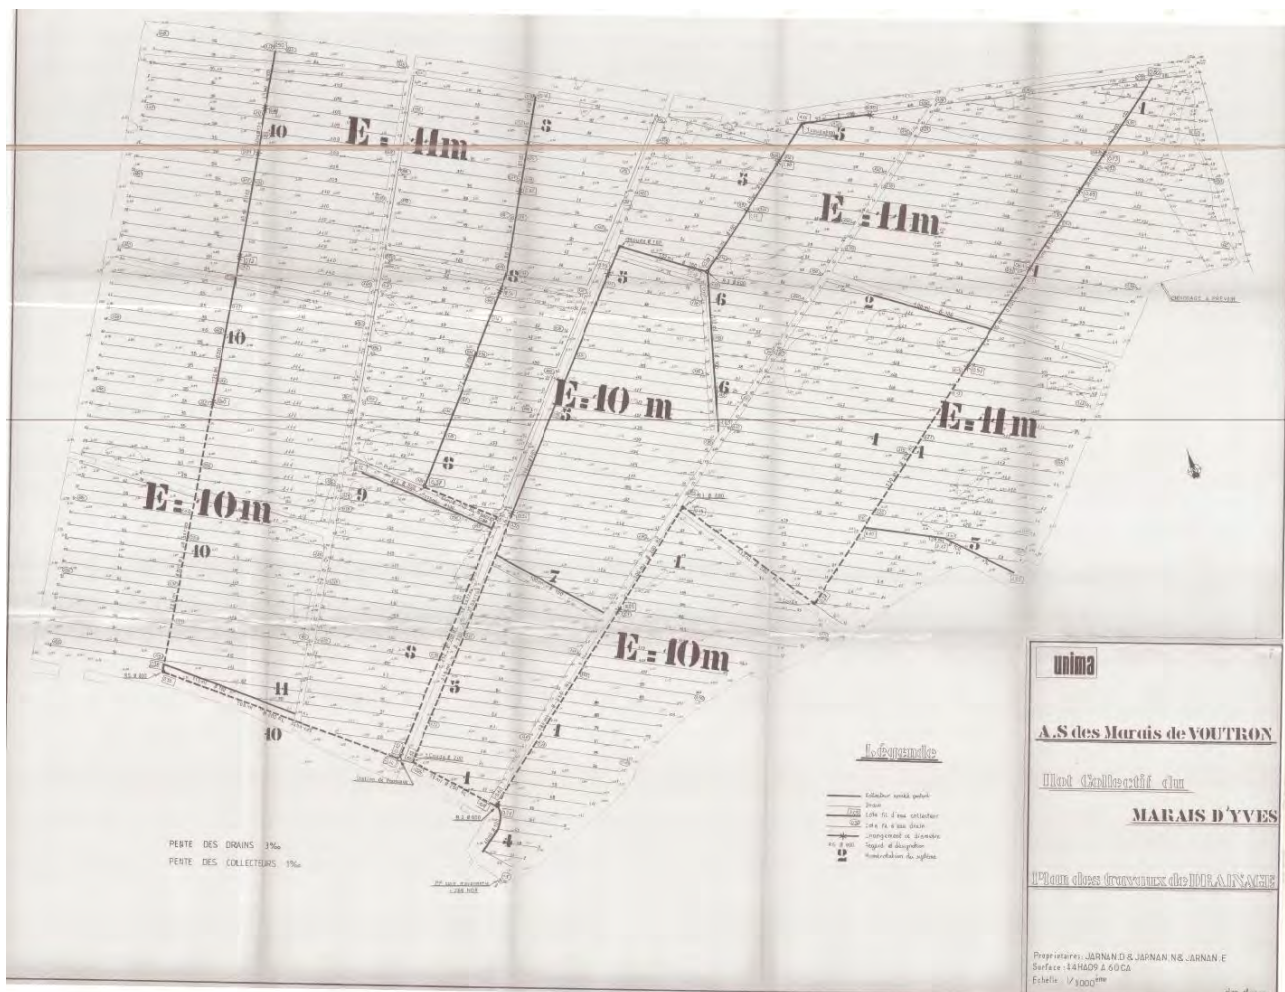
Plan de drainage de la parcelle de la zone d'emprunt n°1
